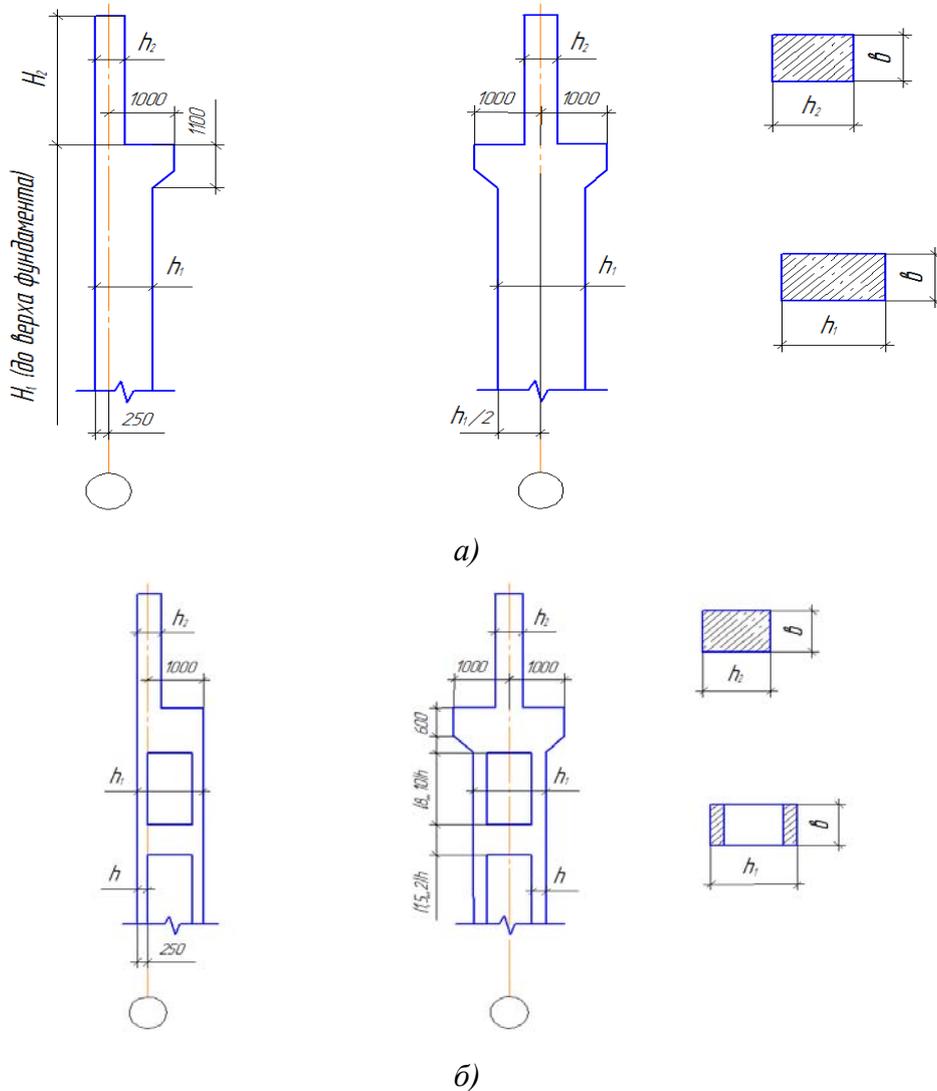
Колонны: а – сплошные; б – двухветвевые
